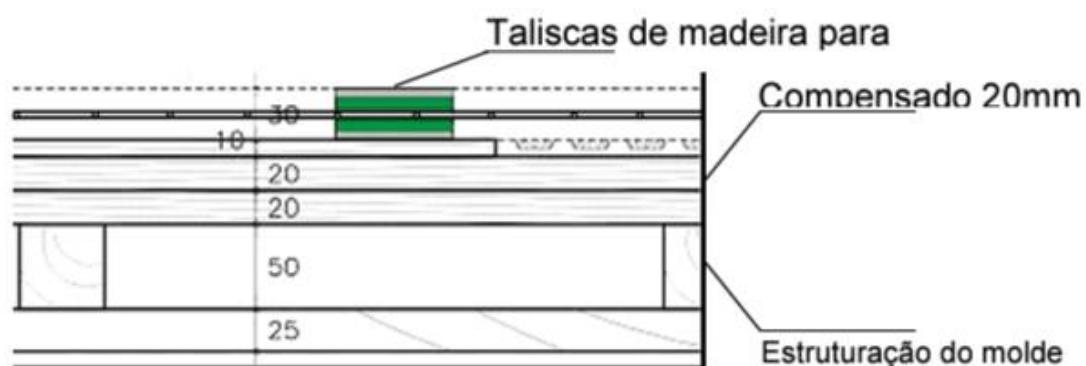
Detalhe da armadura já instalada na fôrma de madeira
